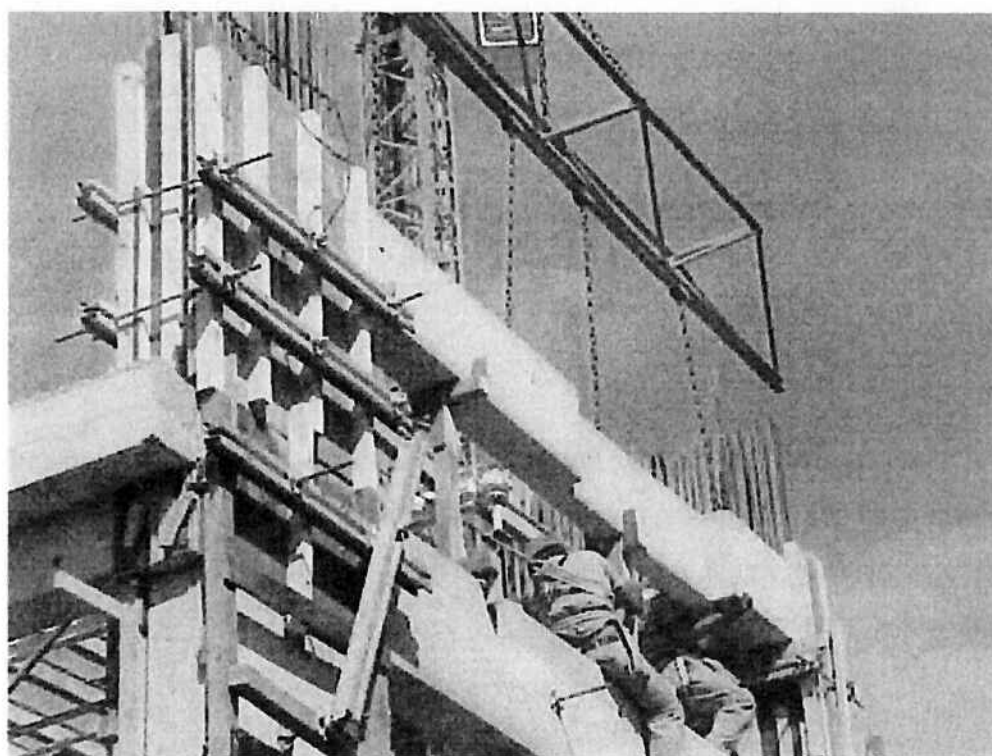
Colocação da pré-viga na fôrma da coluna, com auxílio da treliça metálica e grua
